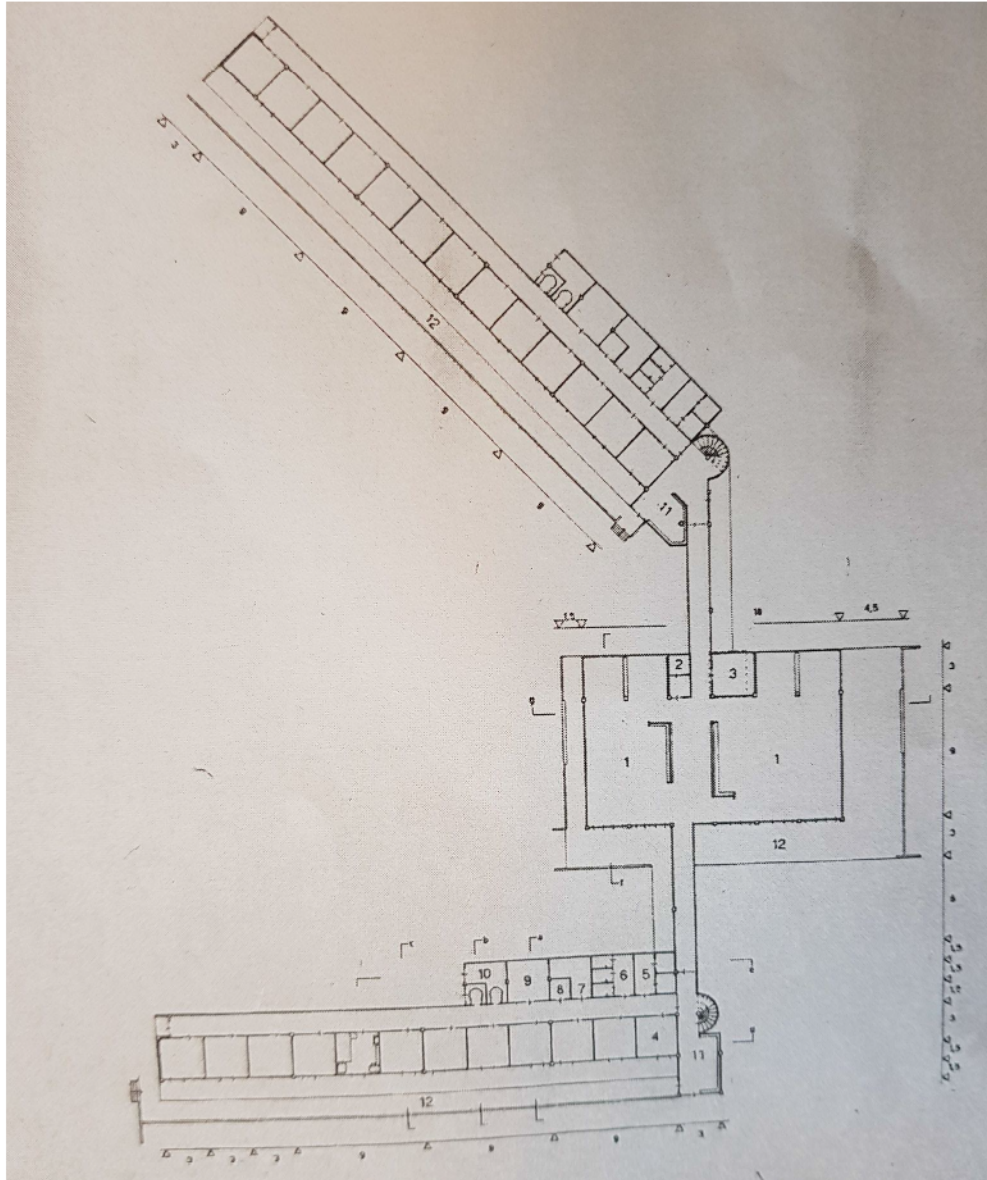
Foto própria da planta de um pavilhão do Sanatório Zonnestraal
